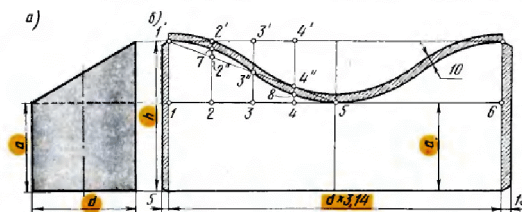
Колено водосточной трубы: а — вид сбоку; б — развертка (шаблон)
